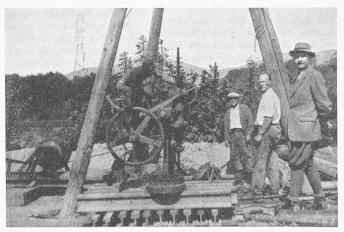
Craelius-Rotationsmaschine AB2 ohne Spülung, Moräne, Bohrung 22
